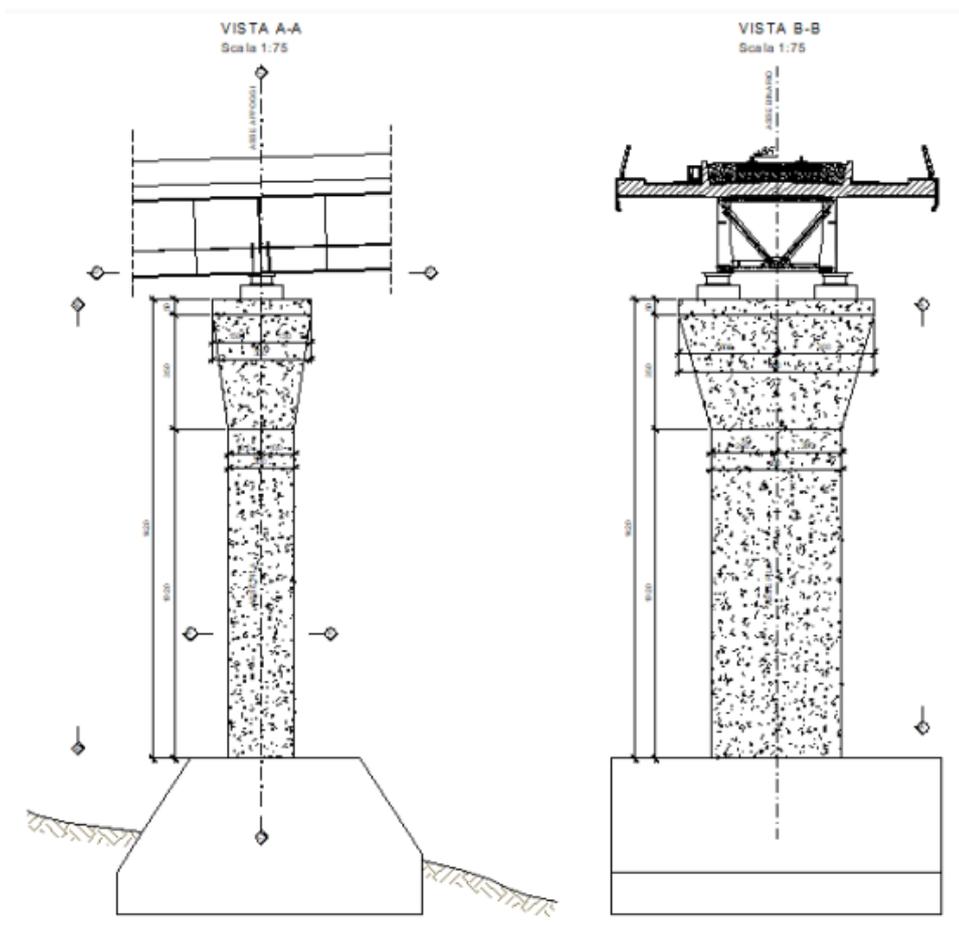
Sezioni pile ponte su fiume Isarco
